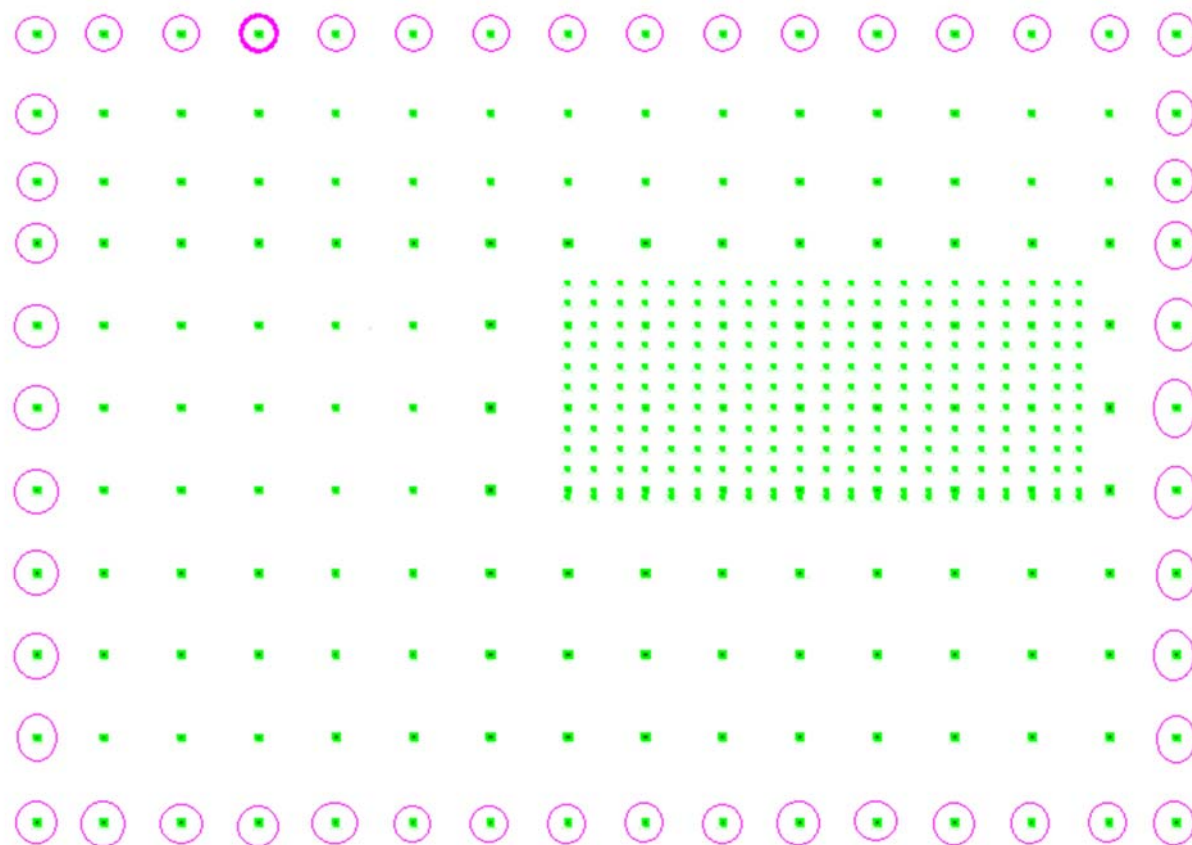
Agrupación de pilares que deben ser muros pantalla. Fuente: CYPE 2015
